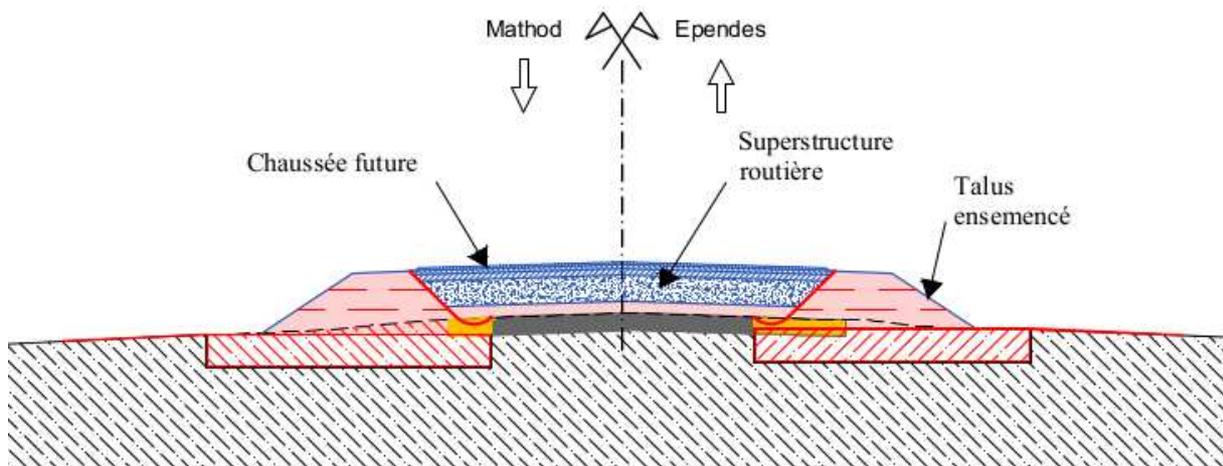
Coupe sur rampe d'accès du pont sur le Mujon avec remblais de préchargement (état final)
